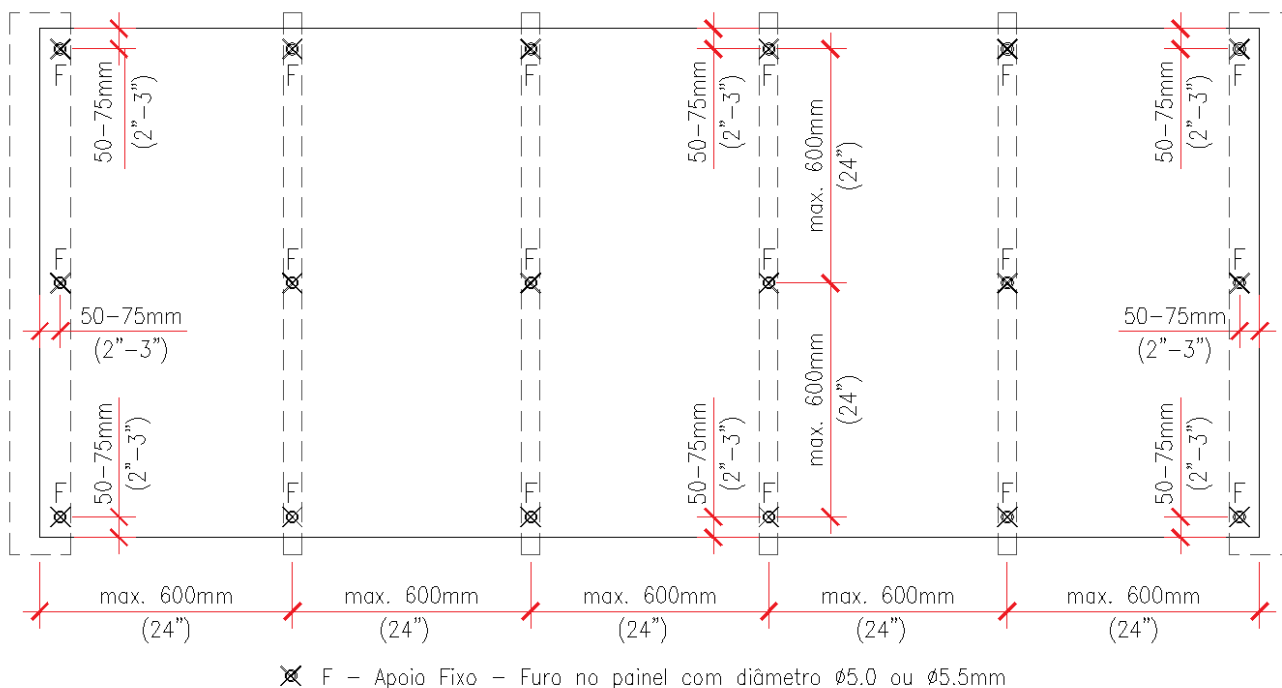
Fixações de painéis de teto, aplicados no interior
